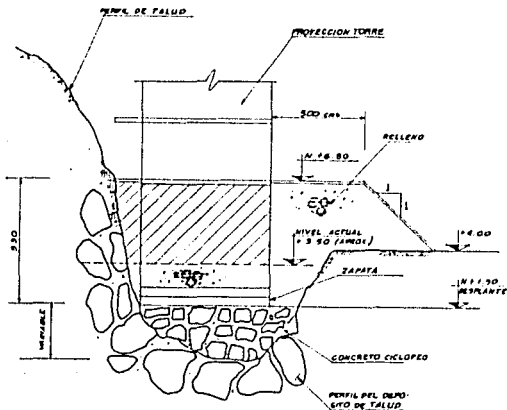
CORTE LONGITUDINAL DE LA SECCION TIPO DE EXCAVACION.
